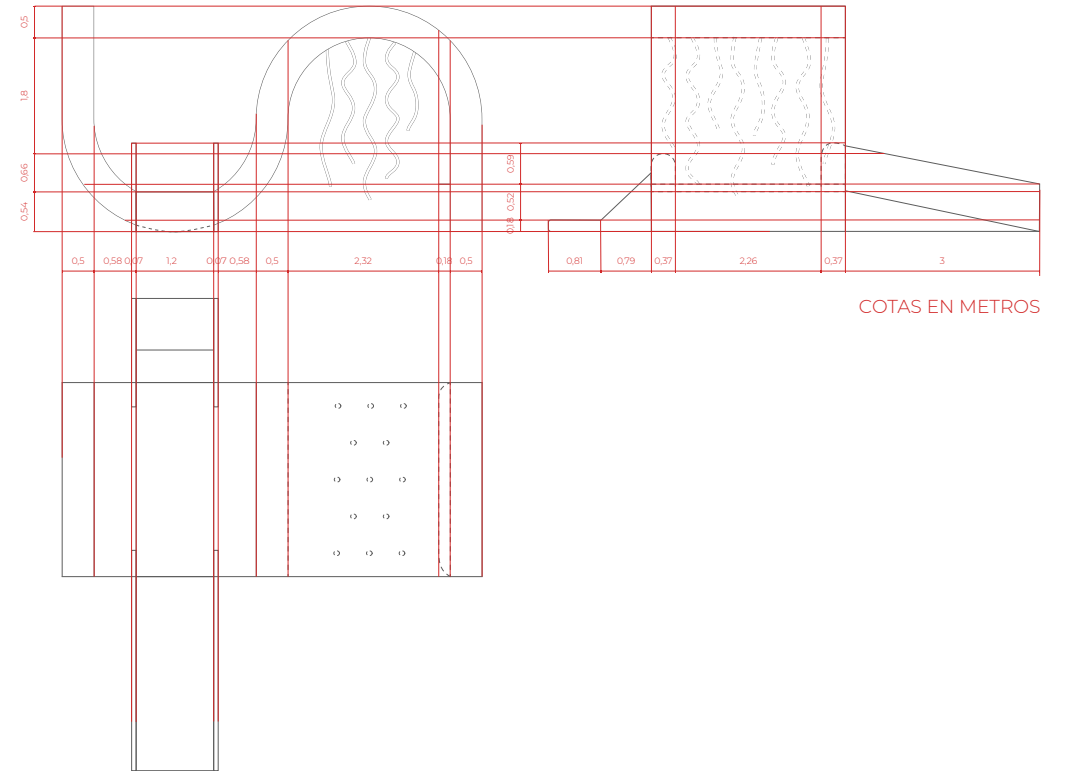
Dibujo Constructivo III. Estructura azul, elaboración propia.
